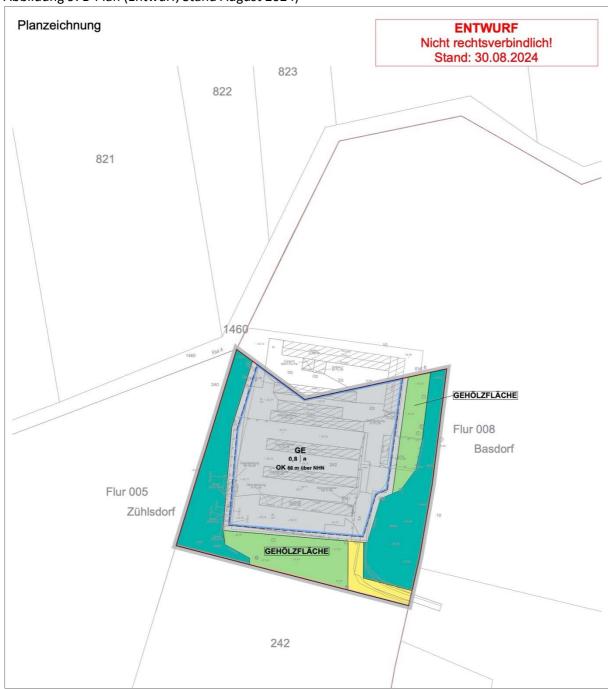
B-Plan (Entwurf, Stand August 2024)
